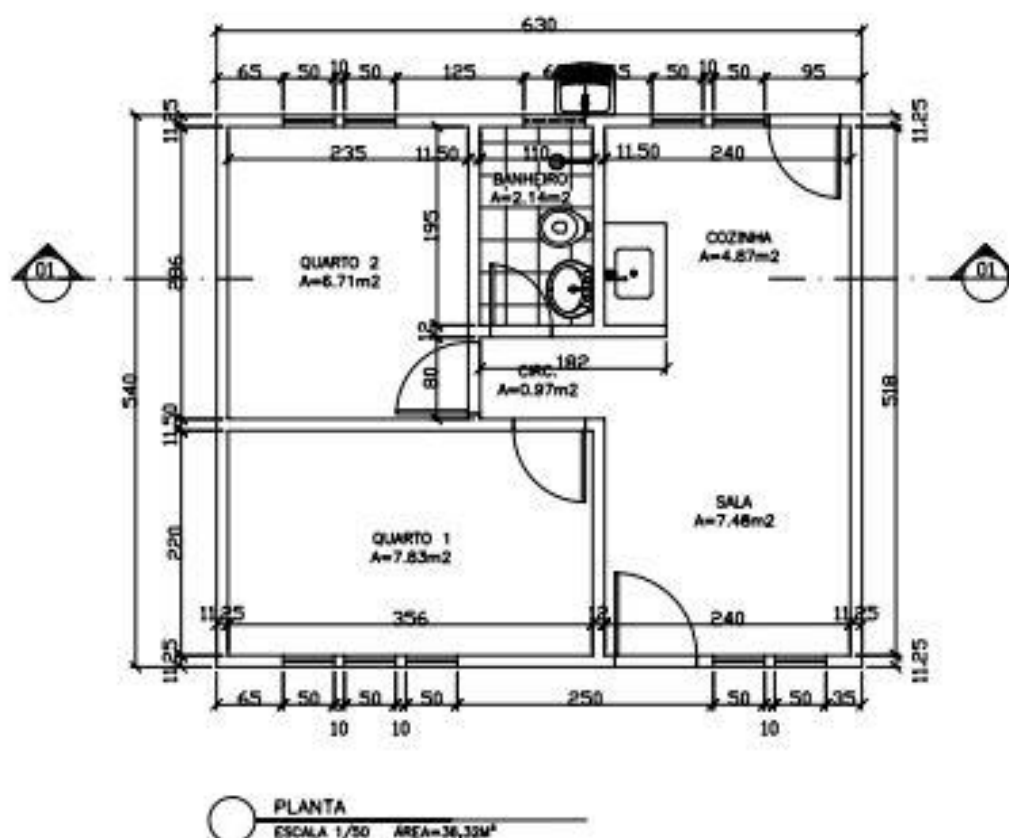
Planta Baixa do Projeto Arquitetônico em Alvenaria Estrutural
